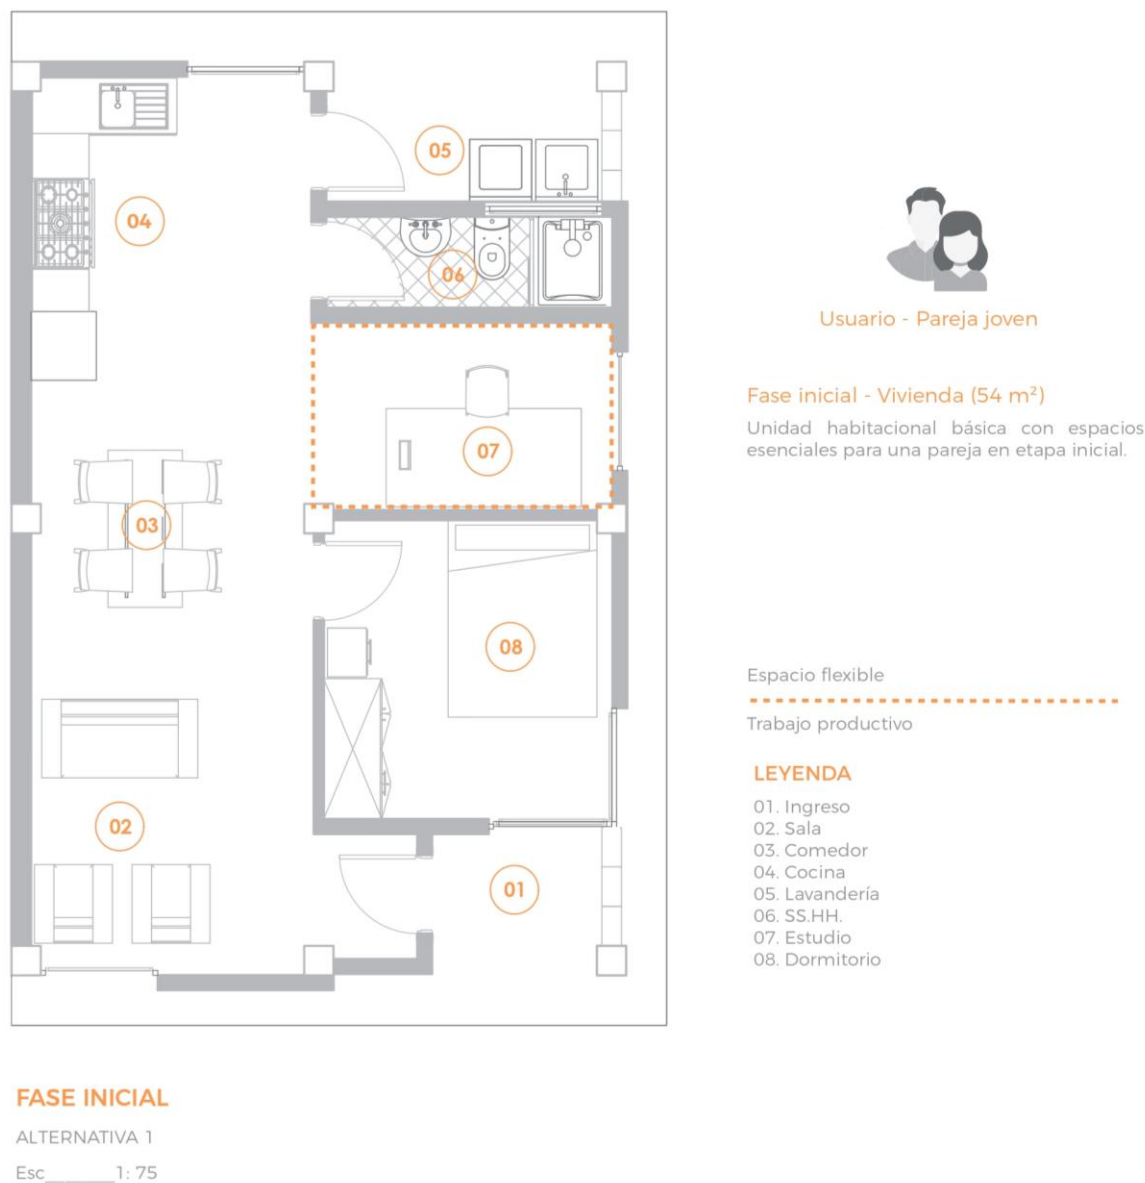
Planta arquitectónica – Alternativa 1 *Nota.* Elaboración propia
